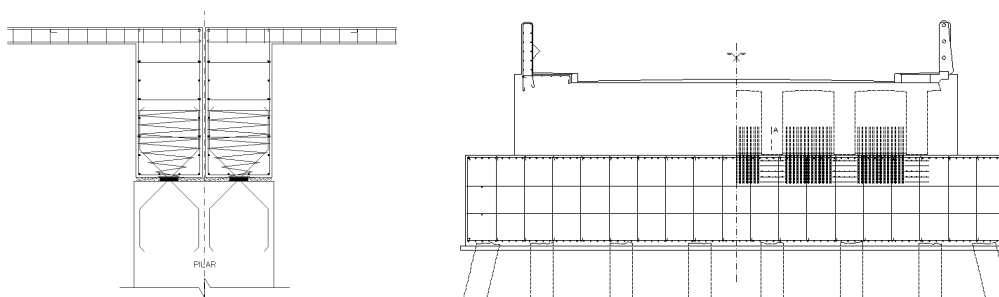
Esquema da fixação com ferrolhos das vigas aos pilares e encontros, respectivamente
